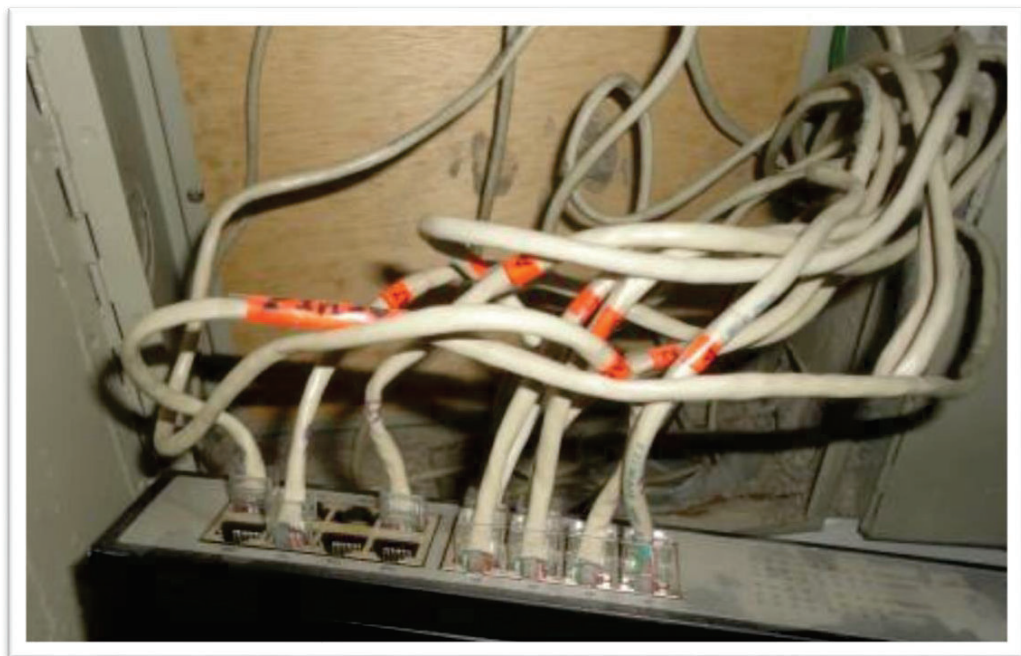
Switch* ubicado en el primer piso Bloque B
